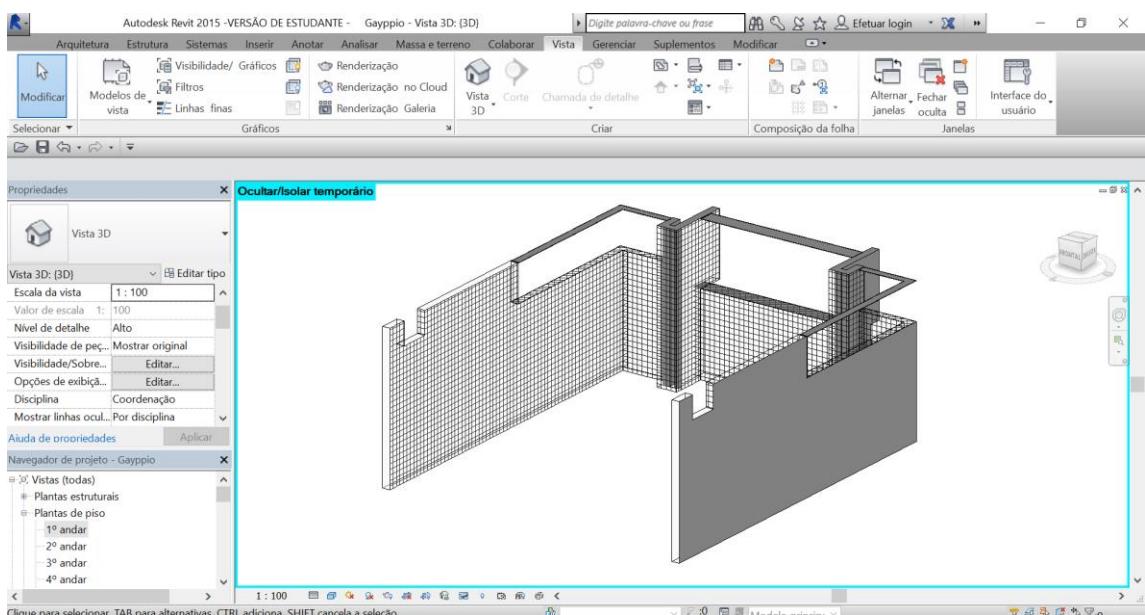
Modelagem do primeiro pavimento em perspectiva.
